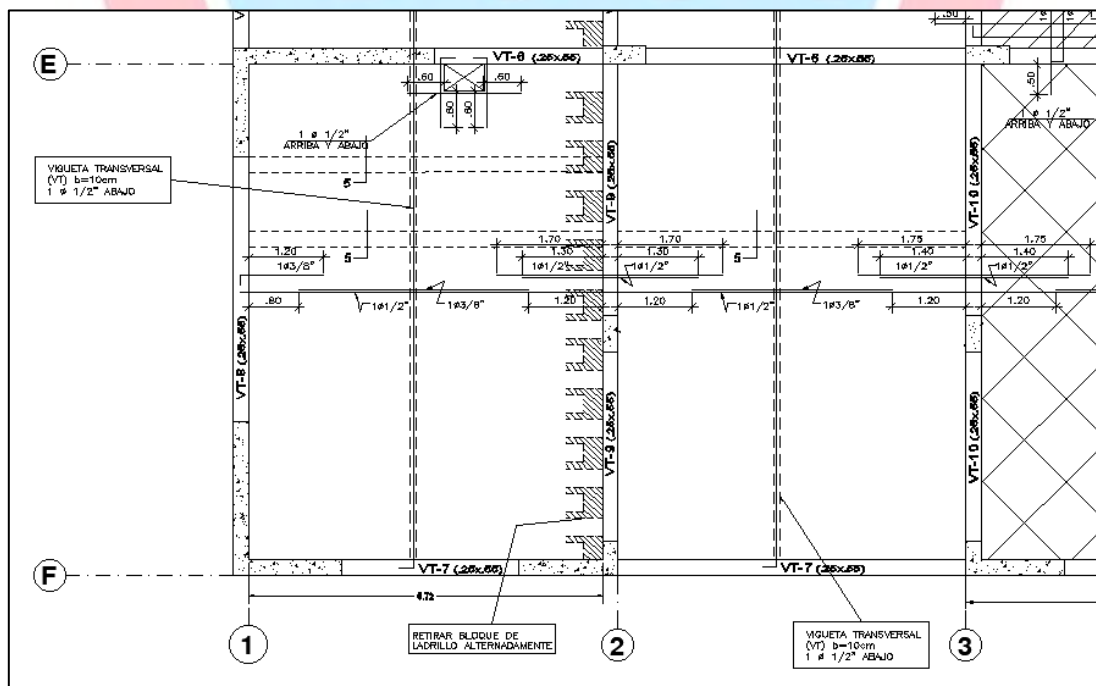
Distribución de refuerzo en losa aligerada con peralte de 0.25 m.
